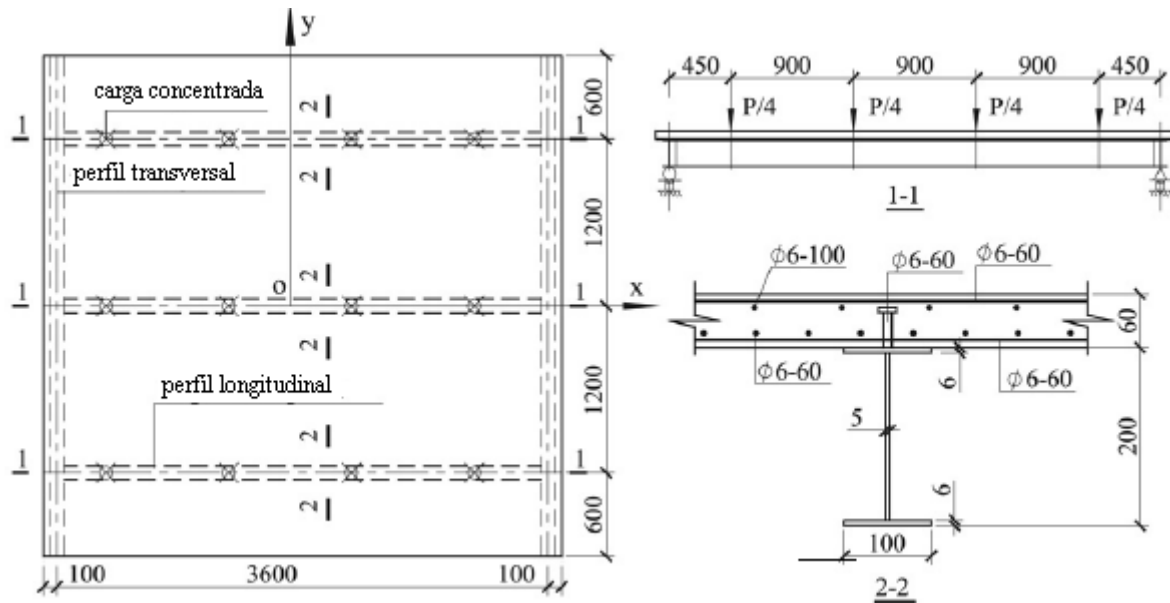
Laje mista aço-concreto (unidades em mm) Nie *et al.* (2008)
